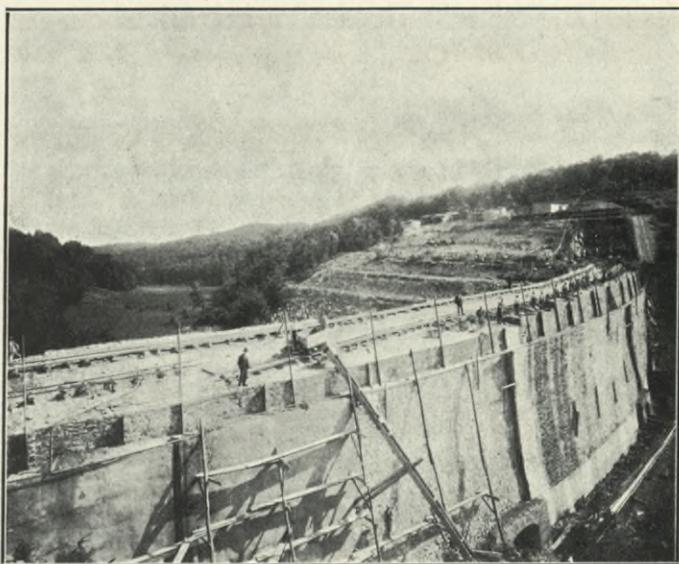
Herbringhauser Thalsperre bei Lüttringhausen.
